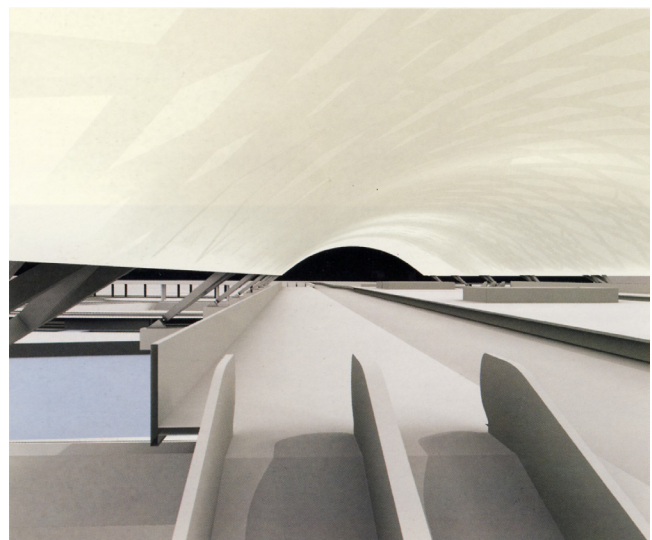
, 54, 54, 56_ Estrutura sobre o Mondego, Planta e corte da proposta, vista interior.
